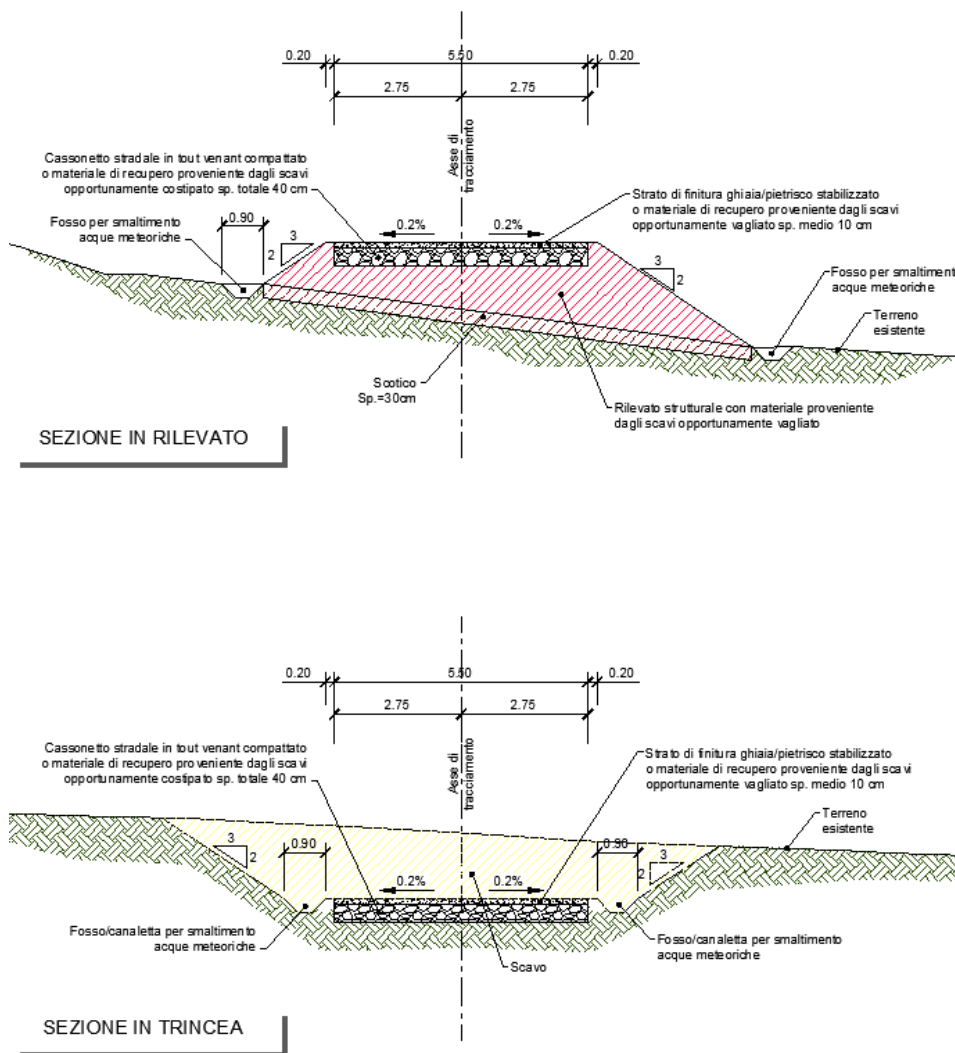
Sezione tipo delle piste di accesso agli aerogeneratori
